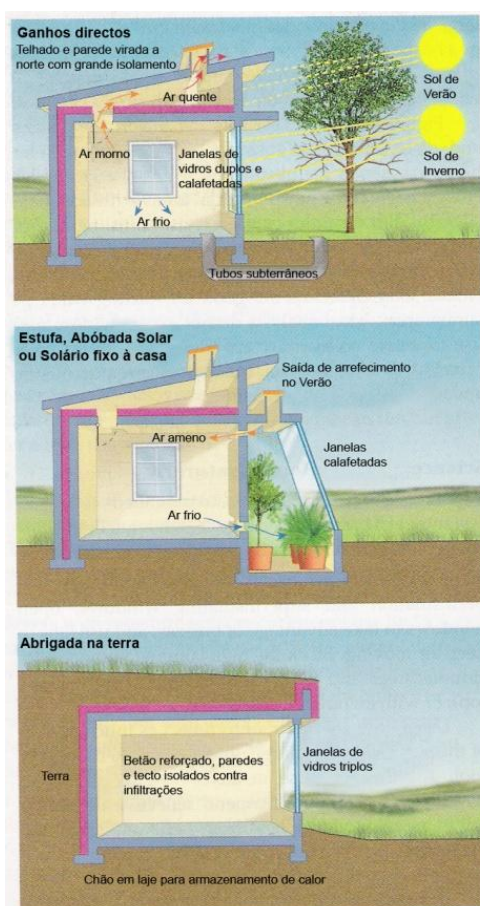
Três exemplos de casas com *design* solar passivo (MILLER, 2006; 314)
